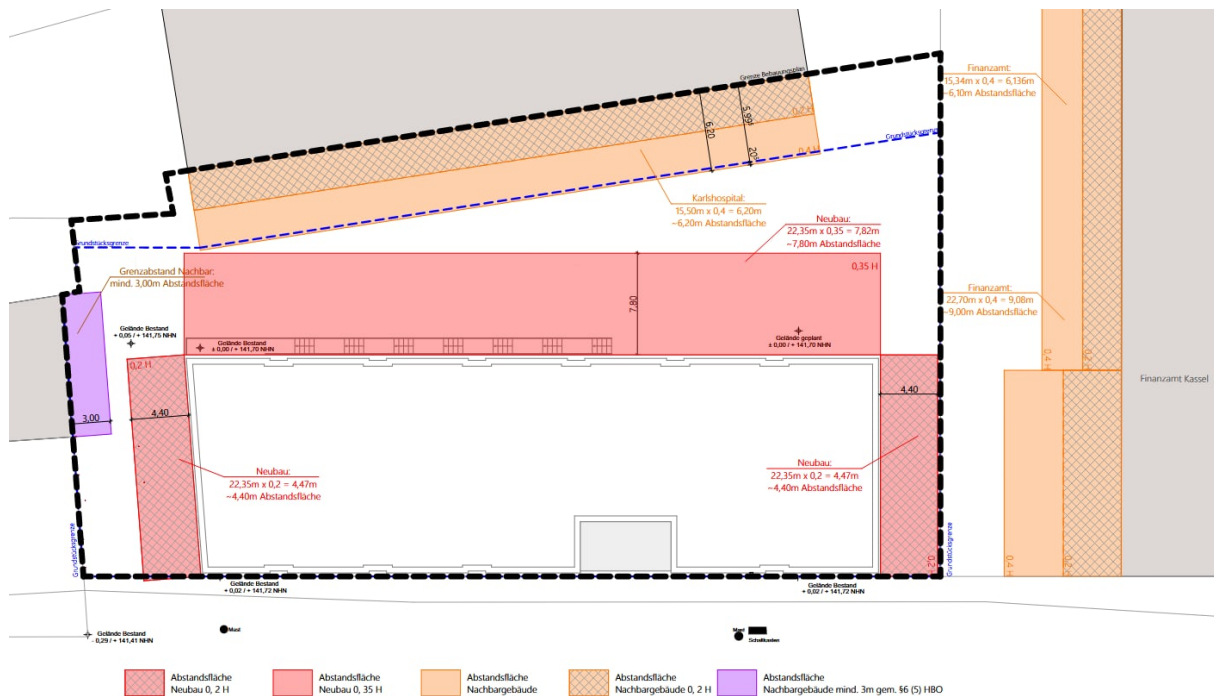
Darstellung der Abstandsflächen in der Draufsicht
